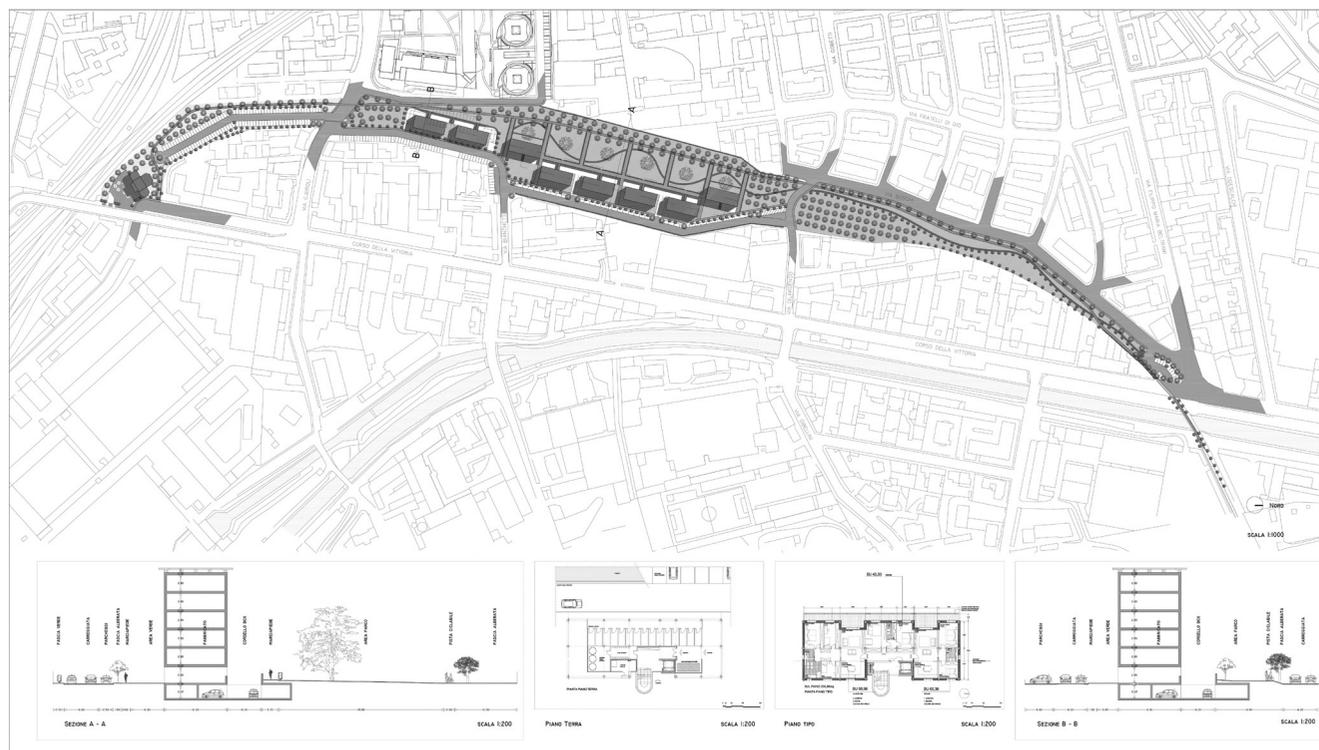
Planivolumetrico e sezioni ambientali dell'ambito di intervento dei CdQ III a seguito della rimodulazione (fonte: elaborazione grafica dell'autore)
